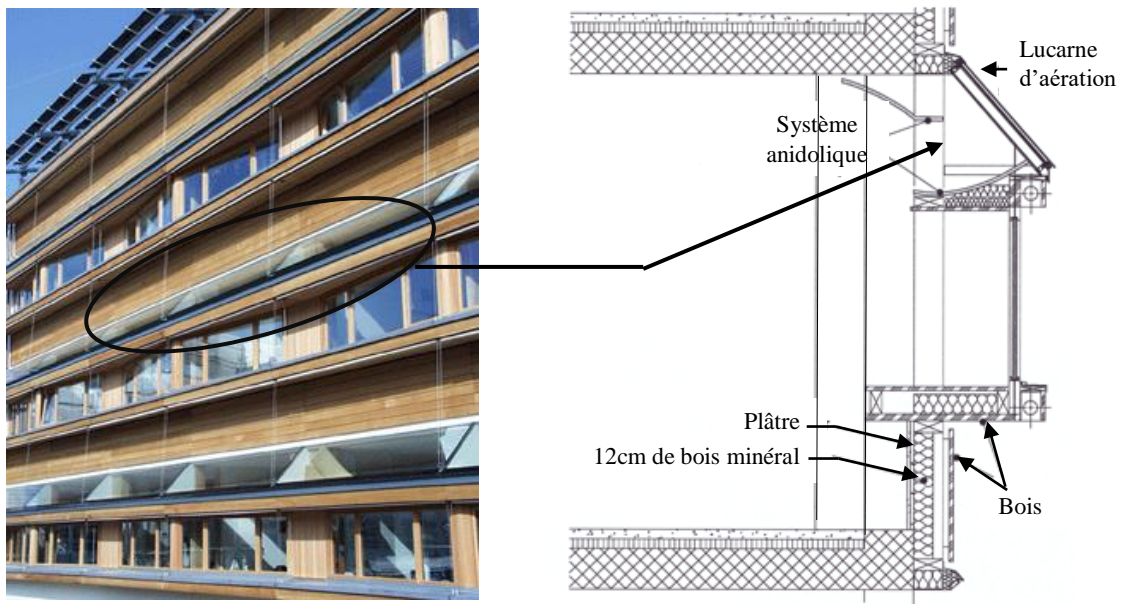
A gauche, Façade rénovée du bâtiment LESO ; A droite, coupe verticale de la façade (Source : /leso.epfl.ch.)
